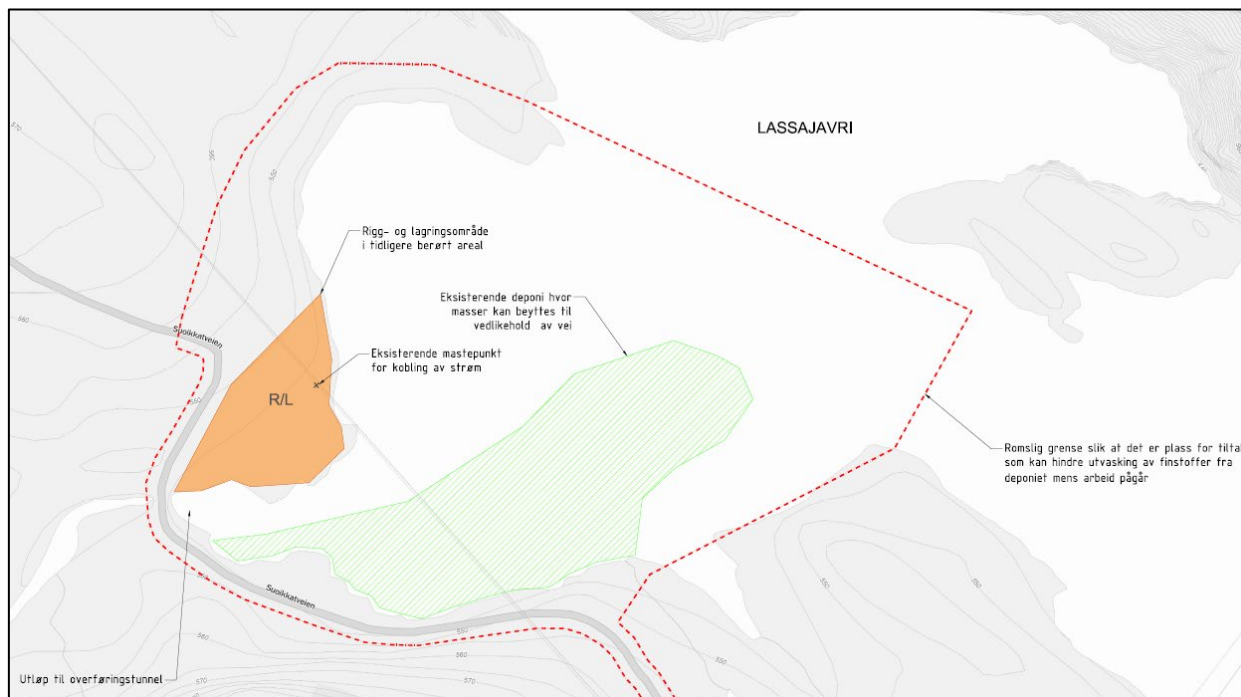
Arealbruksplan Dam Šuoikkátjávri
